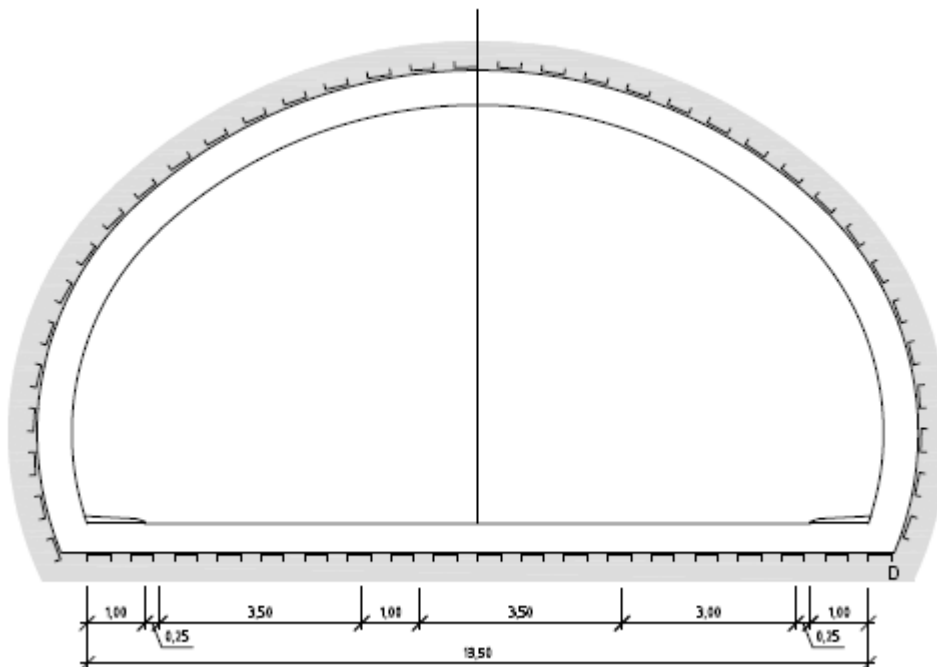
Tunnelprofil T12,5 (mål i m)
